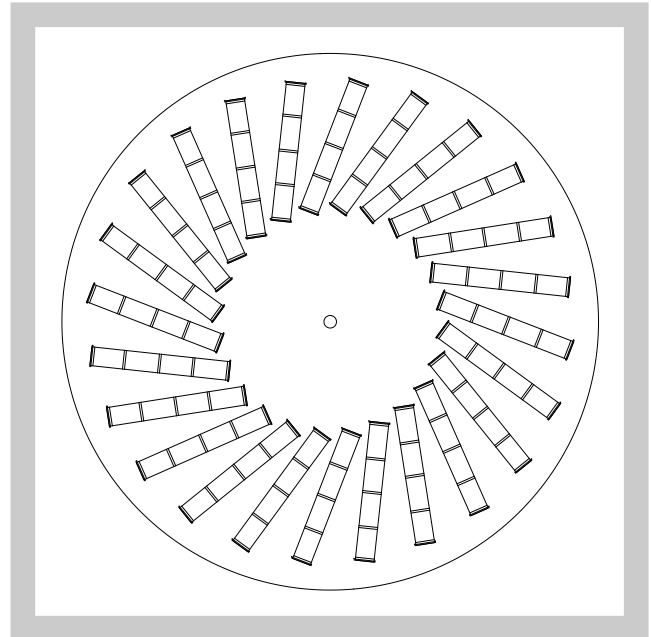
Provedení VVM/C - Čelní deska čtvercová
